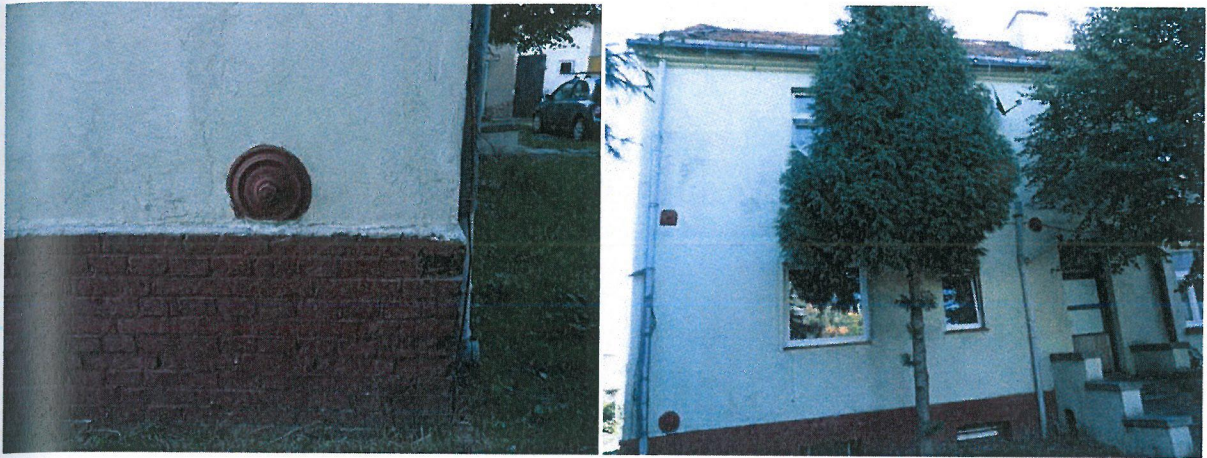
Widok badanego budynku od strony ulicy 1 – go Maja. Widoczna jest elewacja północna, ściana szczytowa i elewacja wschodnia.
